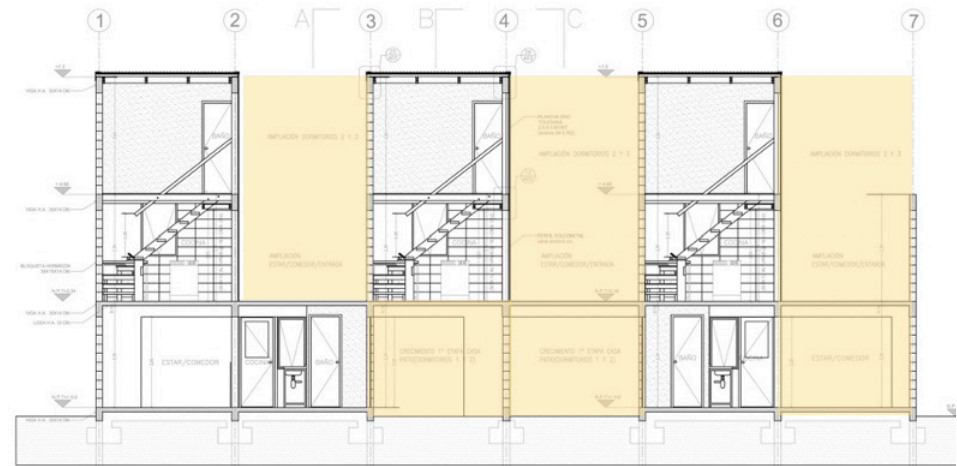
Quinta Monroy , Corte longitudinal (Plataforma Arquitectura, 2007)
